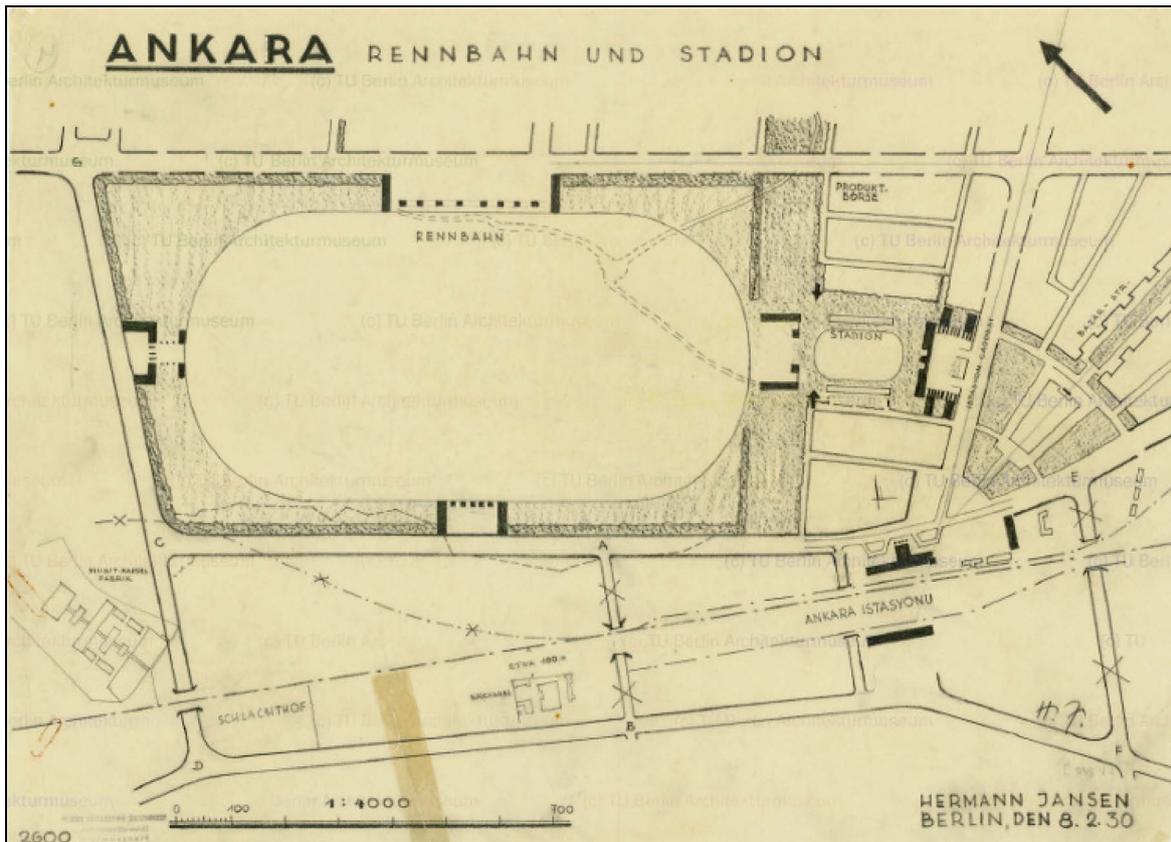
Hermann Jansen, Gesamtbebauungsplan Ankara. Teilbebauungsplan Stadion und Rennbahn, Grund- und Lageplan, 1928.
